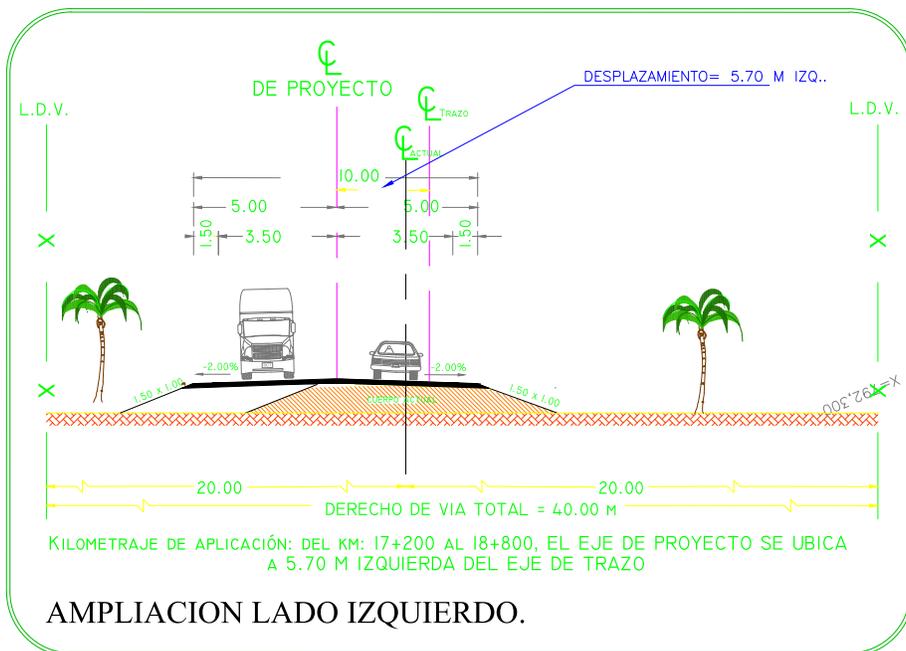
Sección en tangente de camino tipo B, Km 17+200 al Km 18+800
